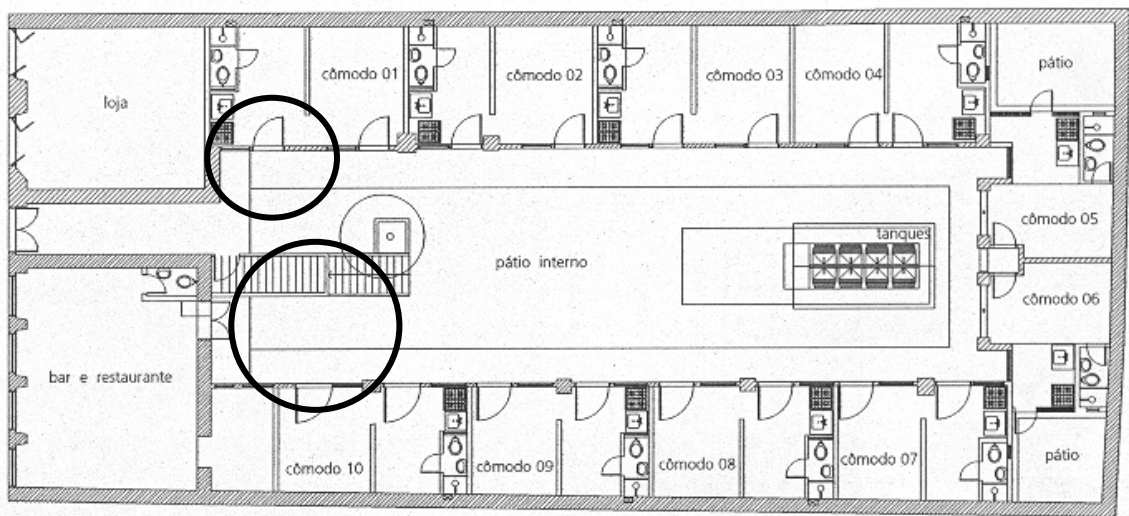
Planta baixa do primeiro pavimento, depois da intervenção. Observa-se a demolição dos dois acréscimos (SECRETARIA, 2000, p. 35).
